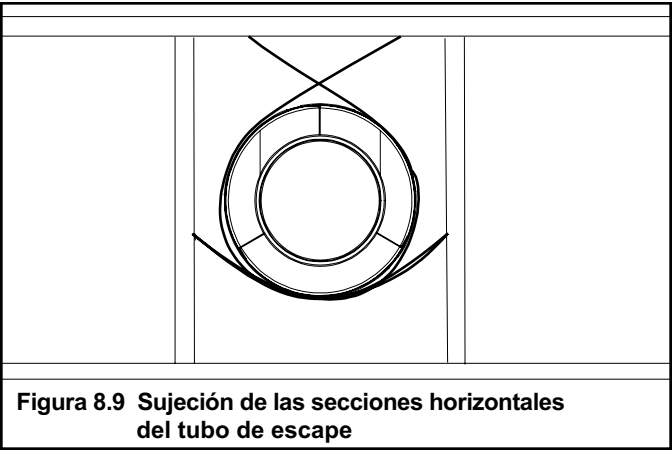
Sujeción de las secciones horizontales del tubo de escape
